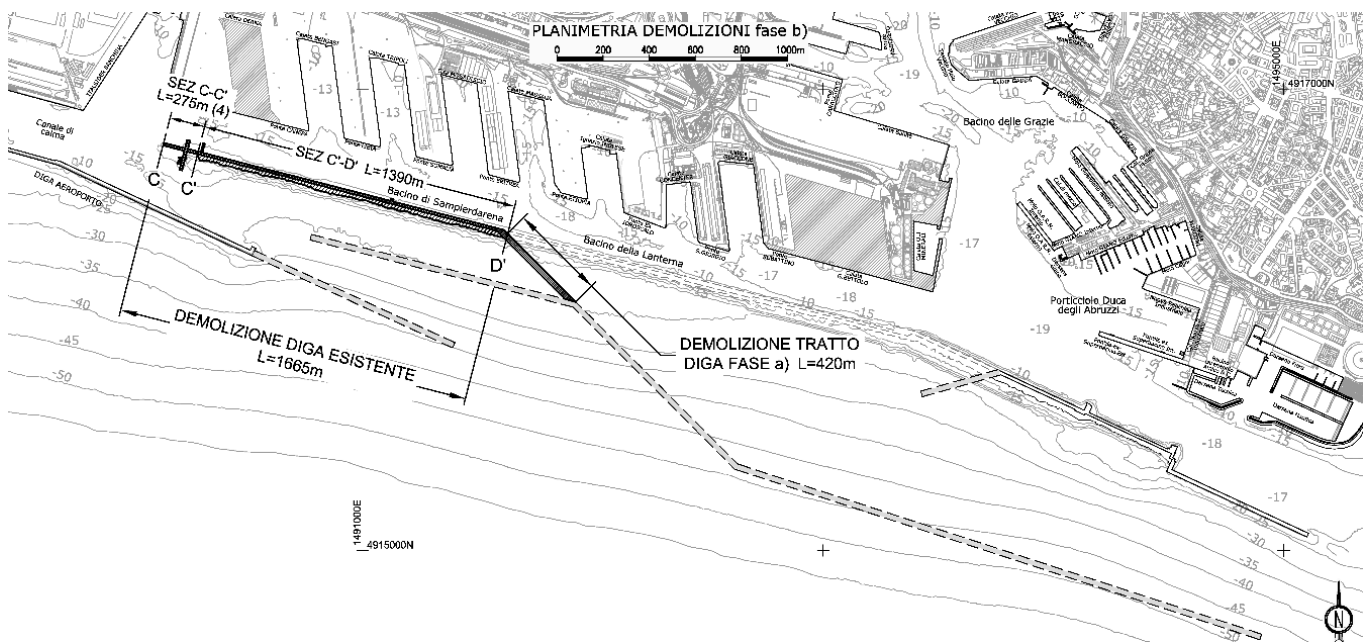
PLANIMETRIA DELLE DEMOLIZIONI PREVISTE IN FASE B)
